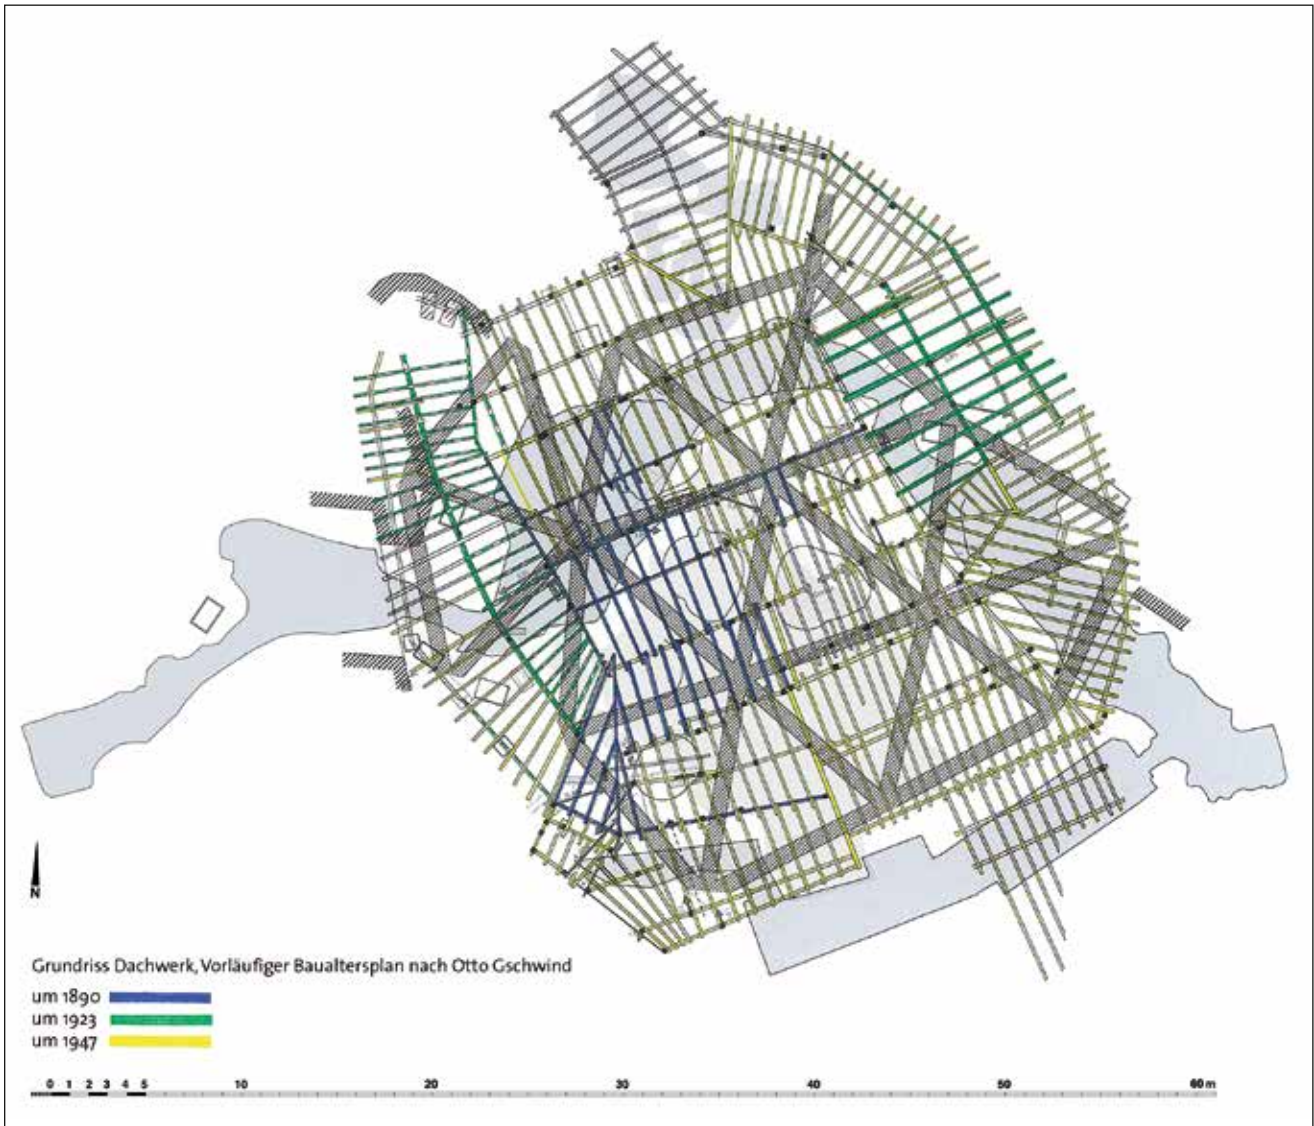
Grundriss des Dachwerks mit Eintragung der ermittelten Bauphasen
